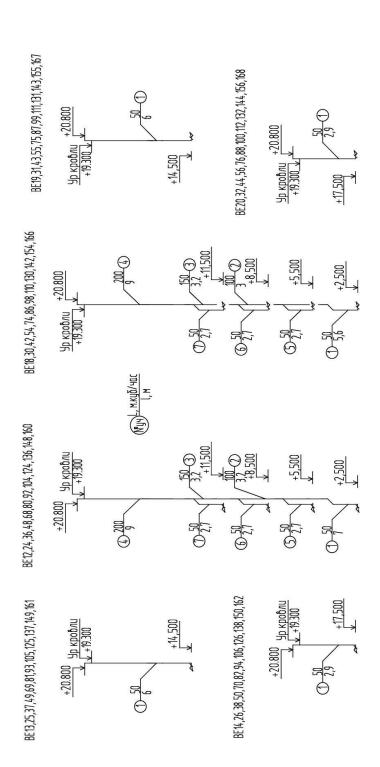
Расчетная схема канальной вентиляции санузлов совмещенных с ванной
